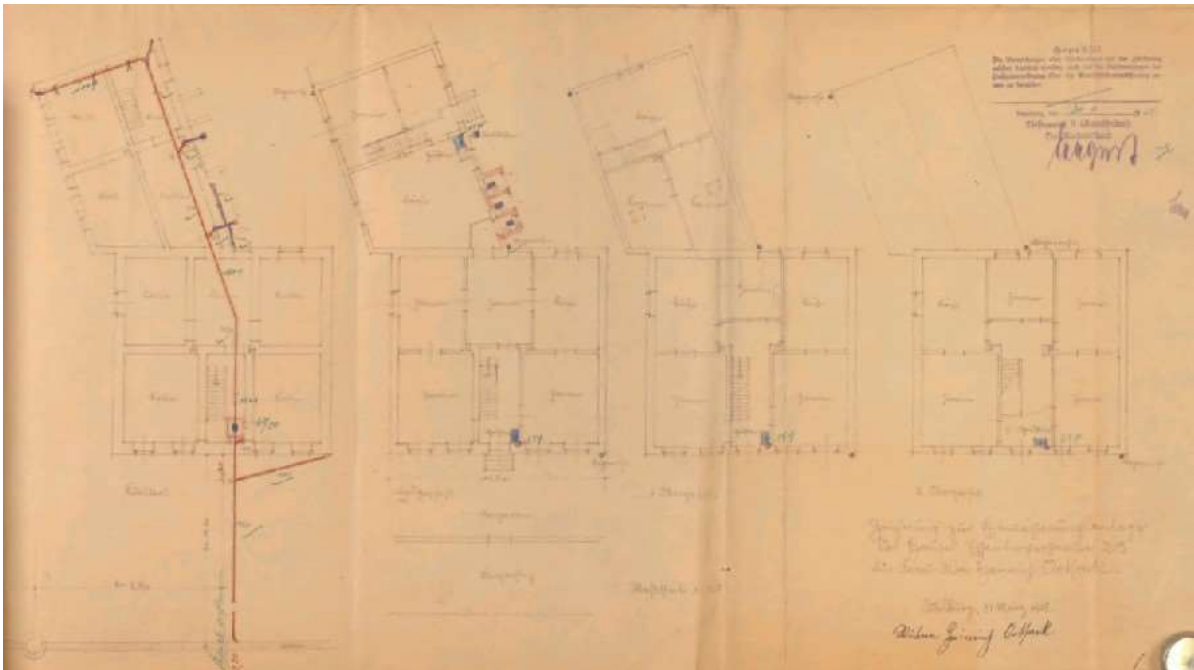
Ursprüngliche Grundrisszeichnungen Quelle: digitale Bauakte Stadt Duisburg
